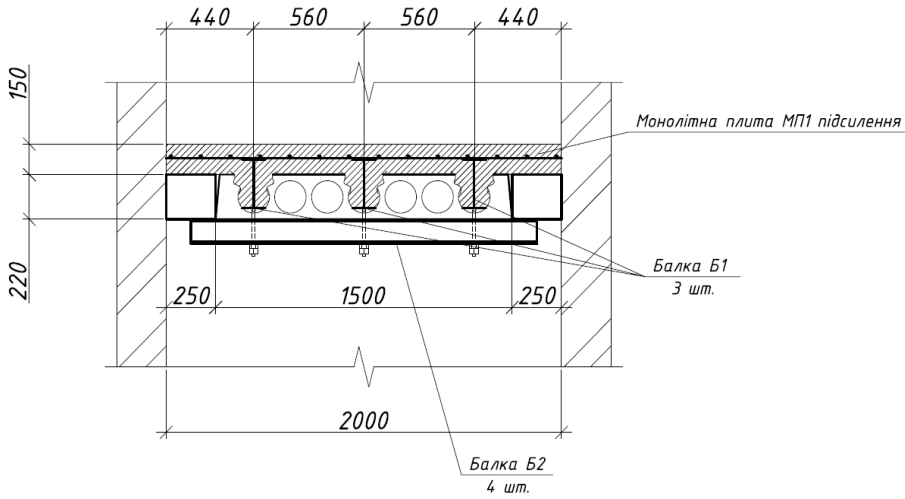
Схема підсилення конструкцій перекриття, поперечний розріз.
